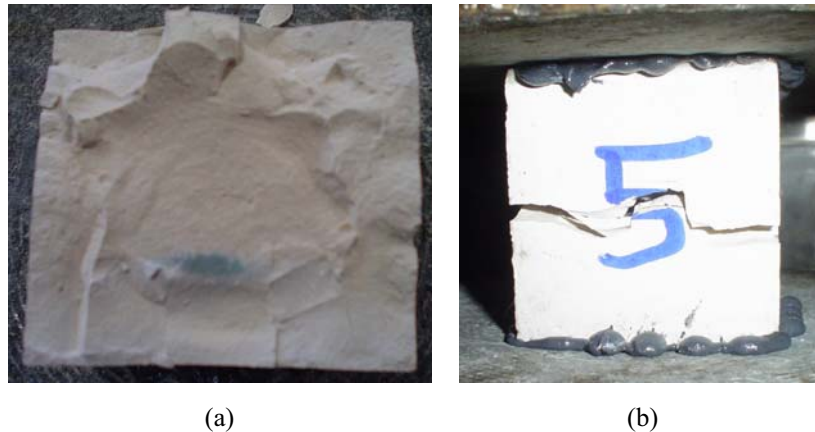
Rotura de um provete de calda de injeção ensaiado à tracção directa: (a) superfície de rotura; (b) fenda de tracção.
